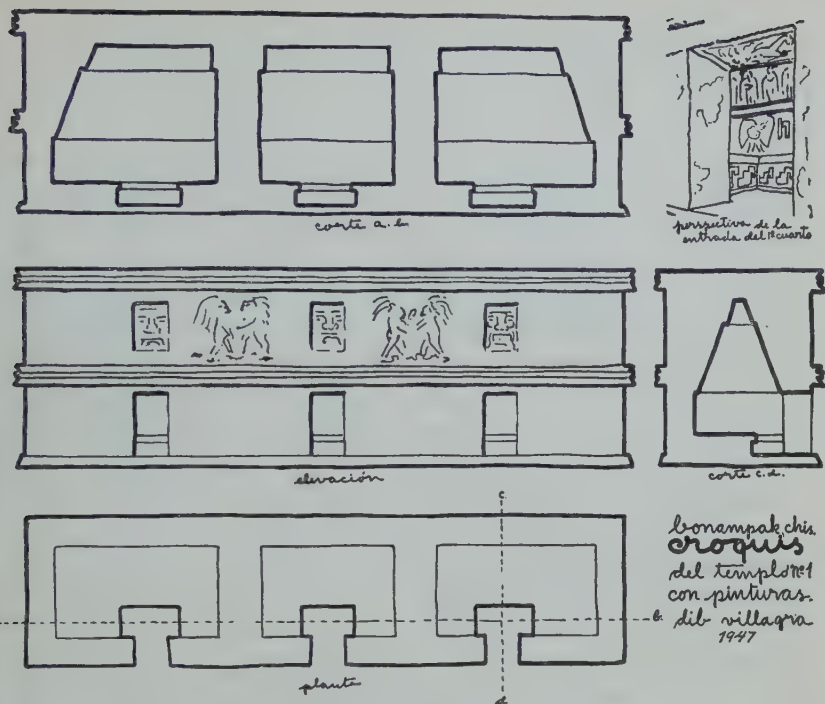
Cortes, fachada y planta del edificio n° 1.
